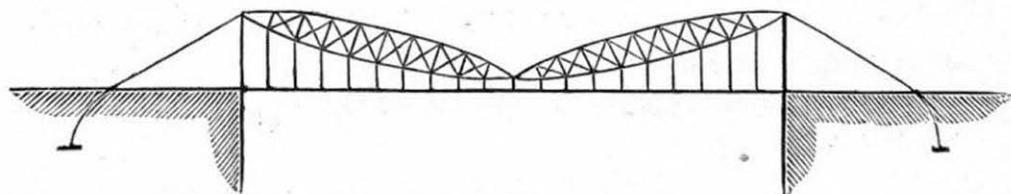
PROYECTO DE PUENTE EN LOS ESTADOS UNIDOS.
